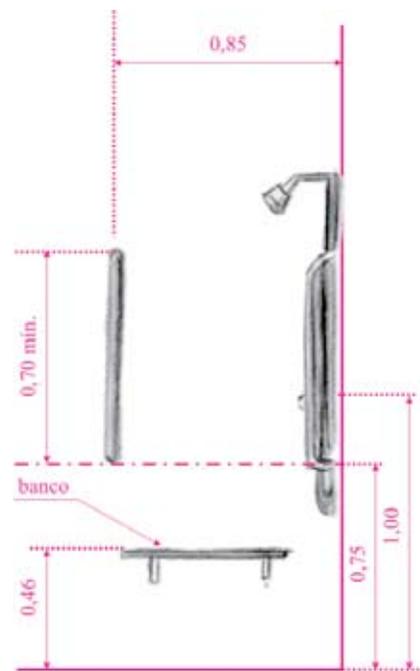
Boxe para chuveiro com barra de apoio em L - Vista lateral
